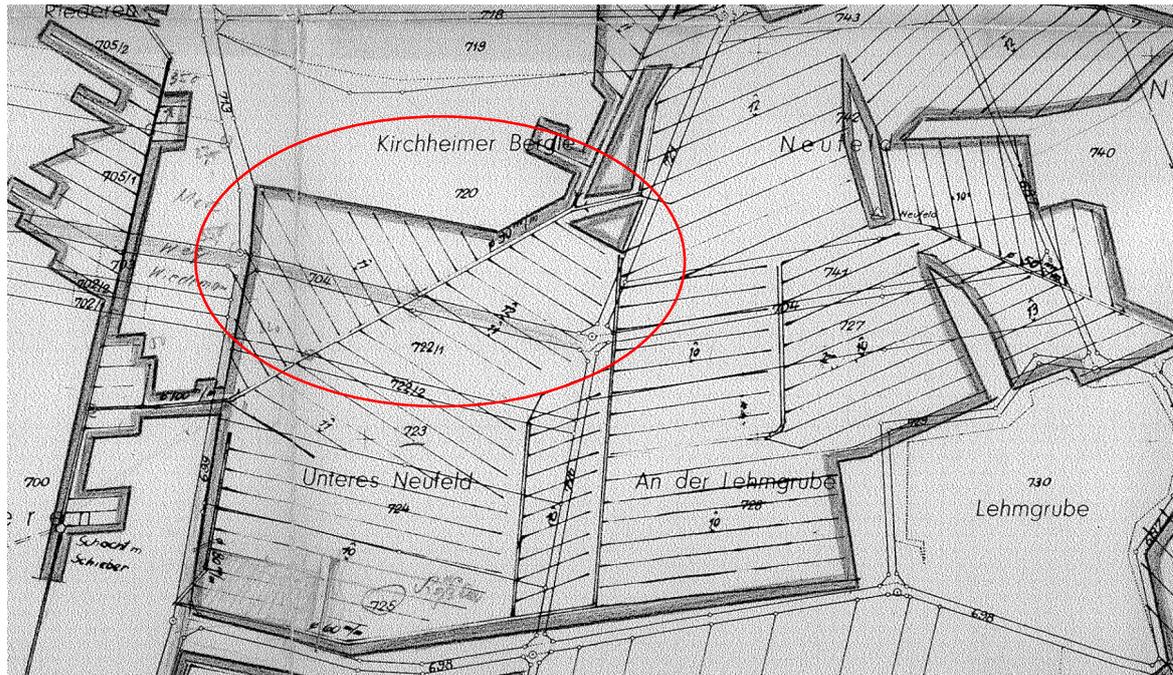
Planausschnitt „Dränung in den Gewanden Neufeld“ mit ungefährender Lage des Plangebiets
